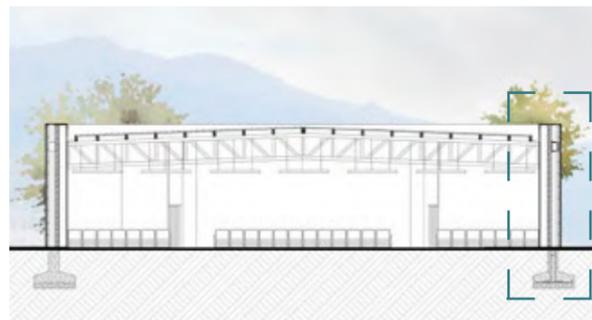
| Sistema constructivo auditorio | Fuente: Elaboración Propia
